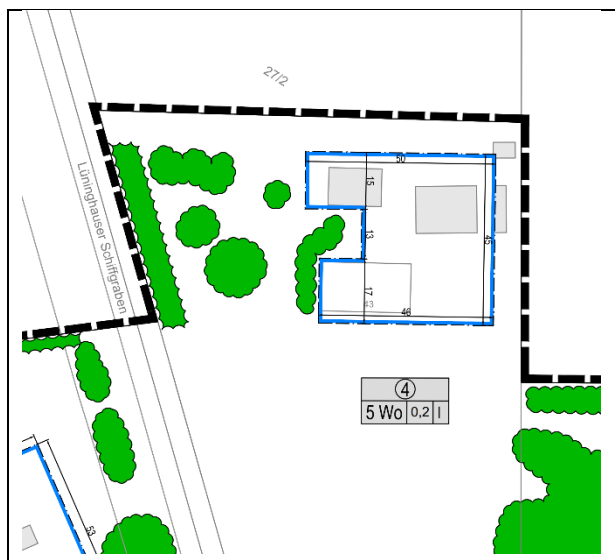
Hausnummer 43 - Lageplan (o.M.)
